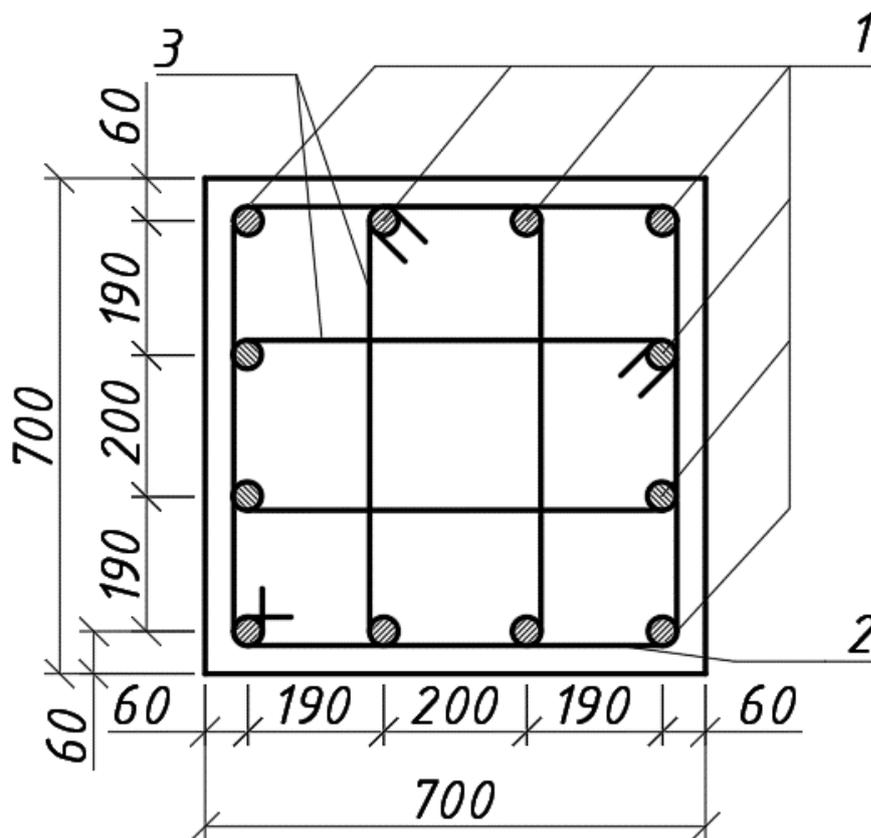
Армирование самой нагруженной колонны в первом варианте конструирования
